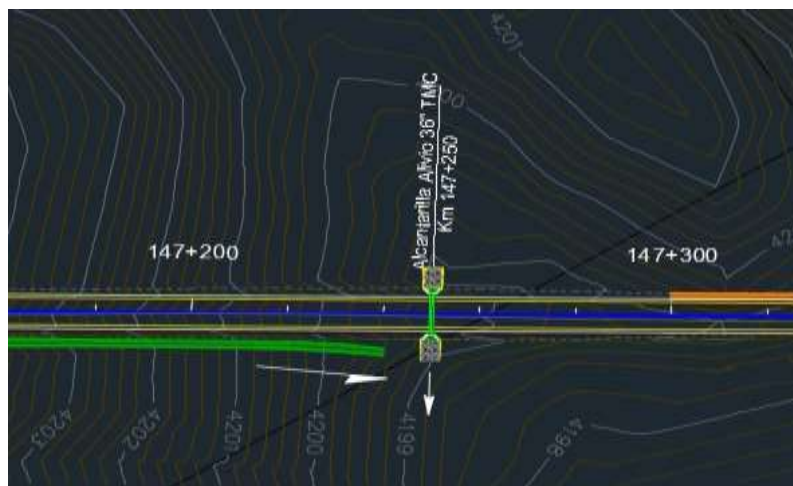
Plano de Sistema de Drenaje Proyectado. (Fuente: Proyecto Integración Vial Tacna – La Paz, Tramo: Tacna – Collpa (Frontera con Bolivia), Sub Tramo 3: Km 146+180 – Km 187+404).
